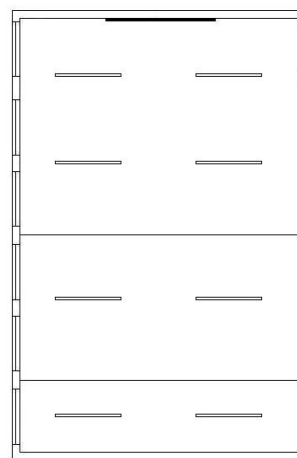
Croqui da sala (destaque para as vigas e luminárias)
